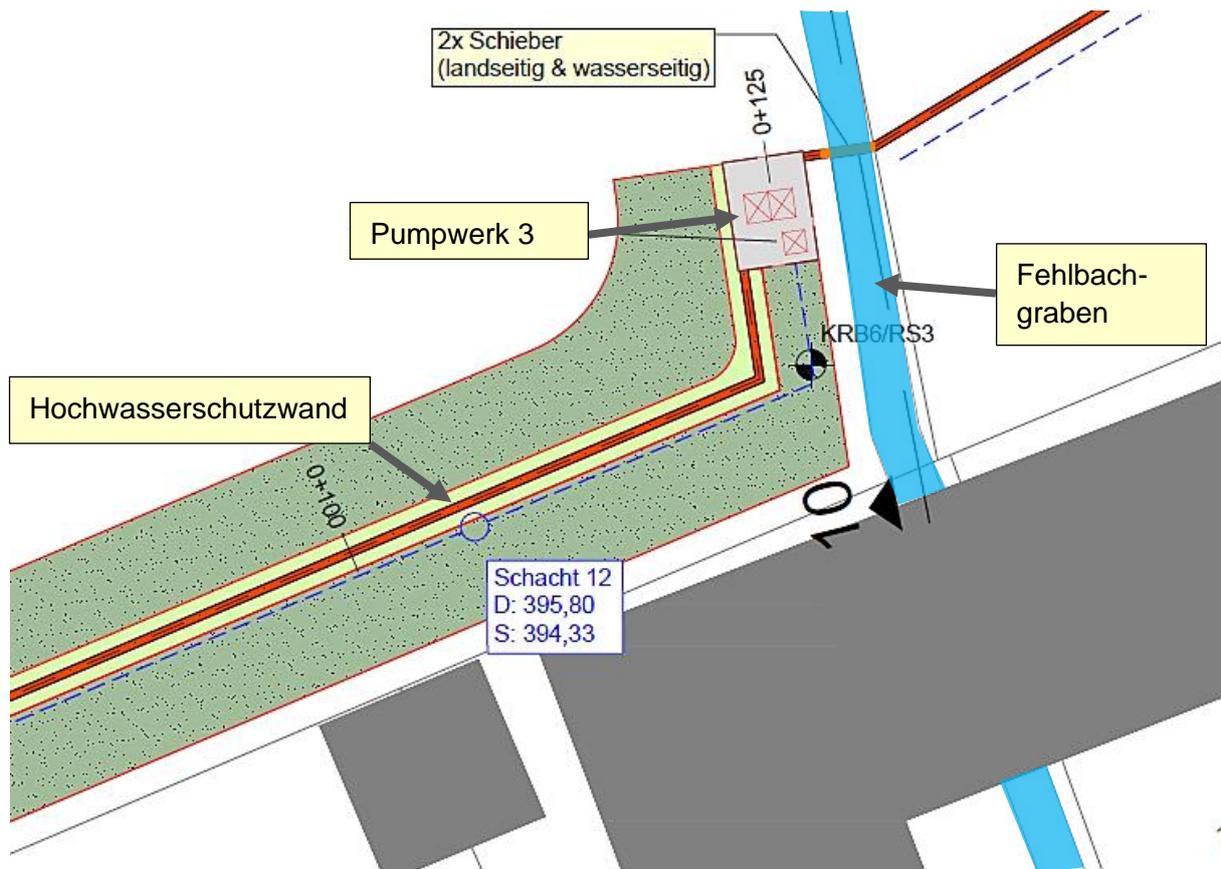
Lage des Pumpwerks 3 (Ausschnitt aus Lageplan E 22)
